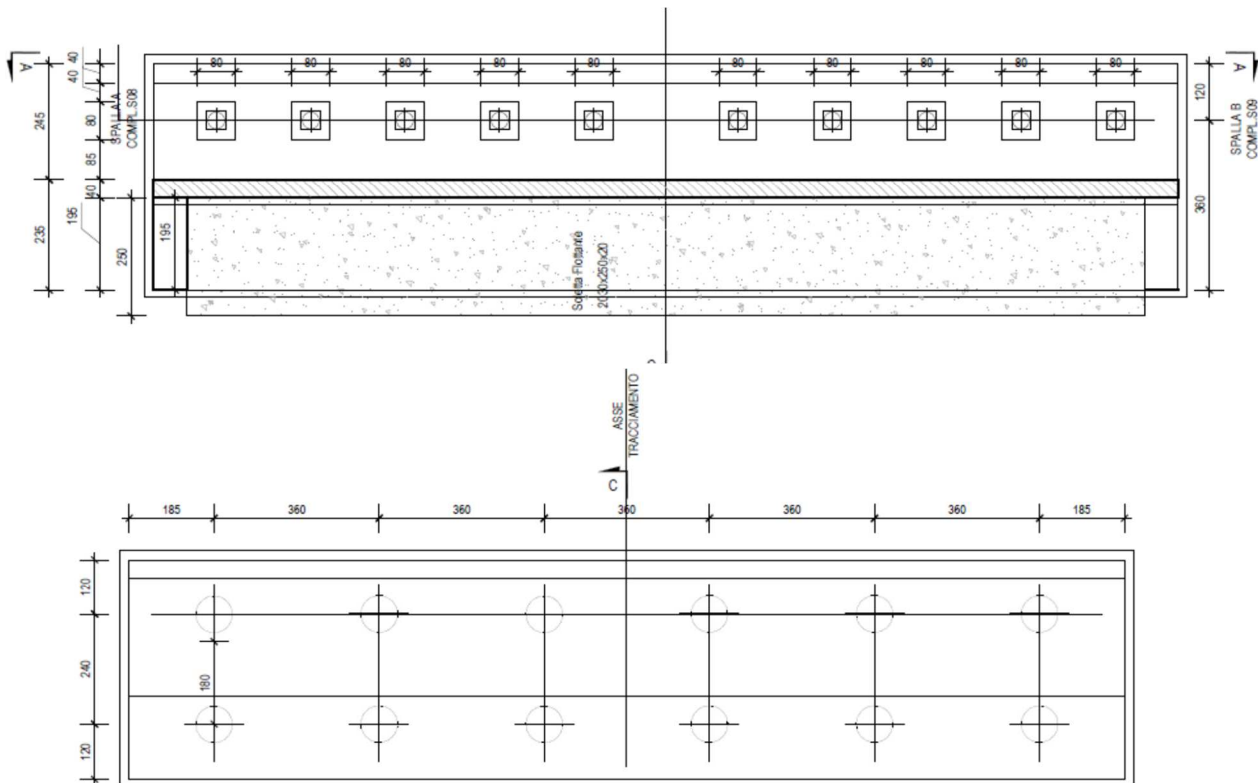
Pianta carpenteria - Spalla tipo
